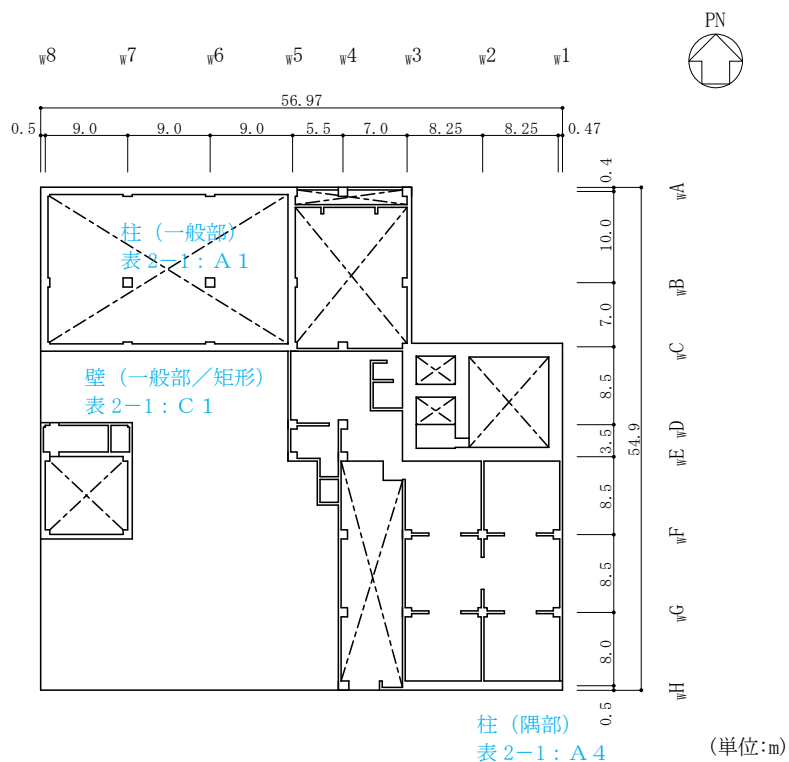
(8) 廃棄物処理建物の概略平面図 (EL 37.5m)
